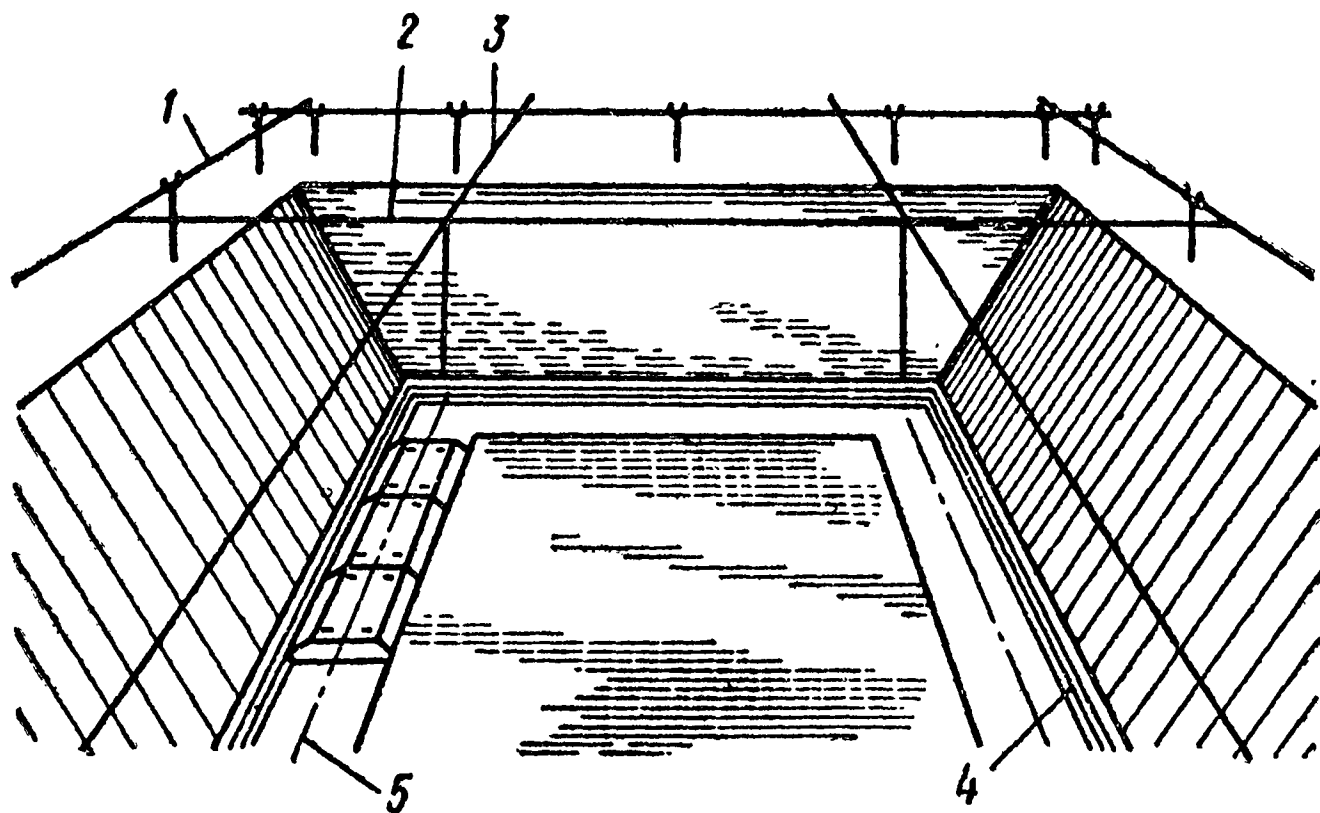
Схема разбивки сборного ленточного фундамента
